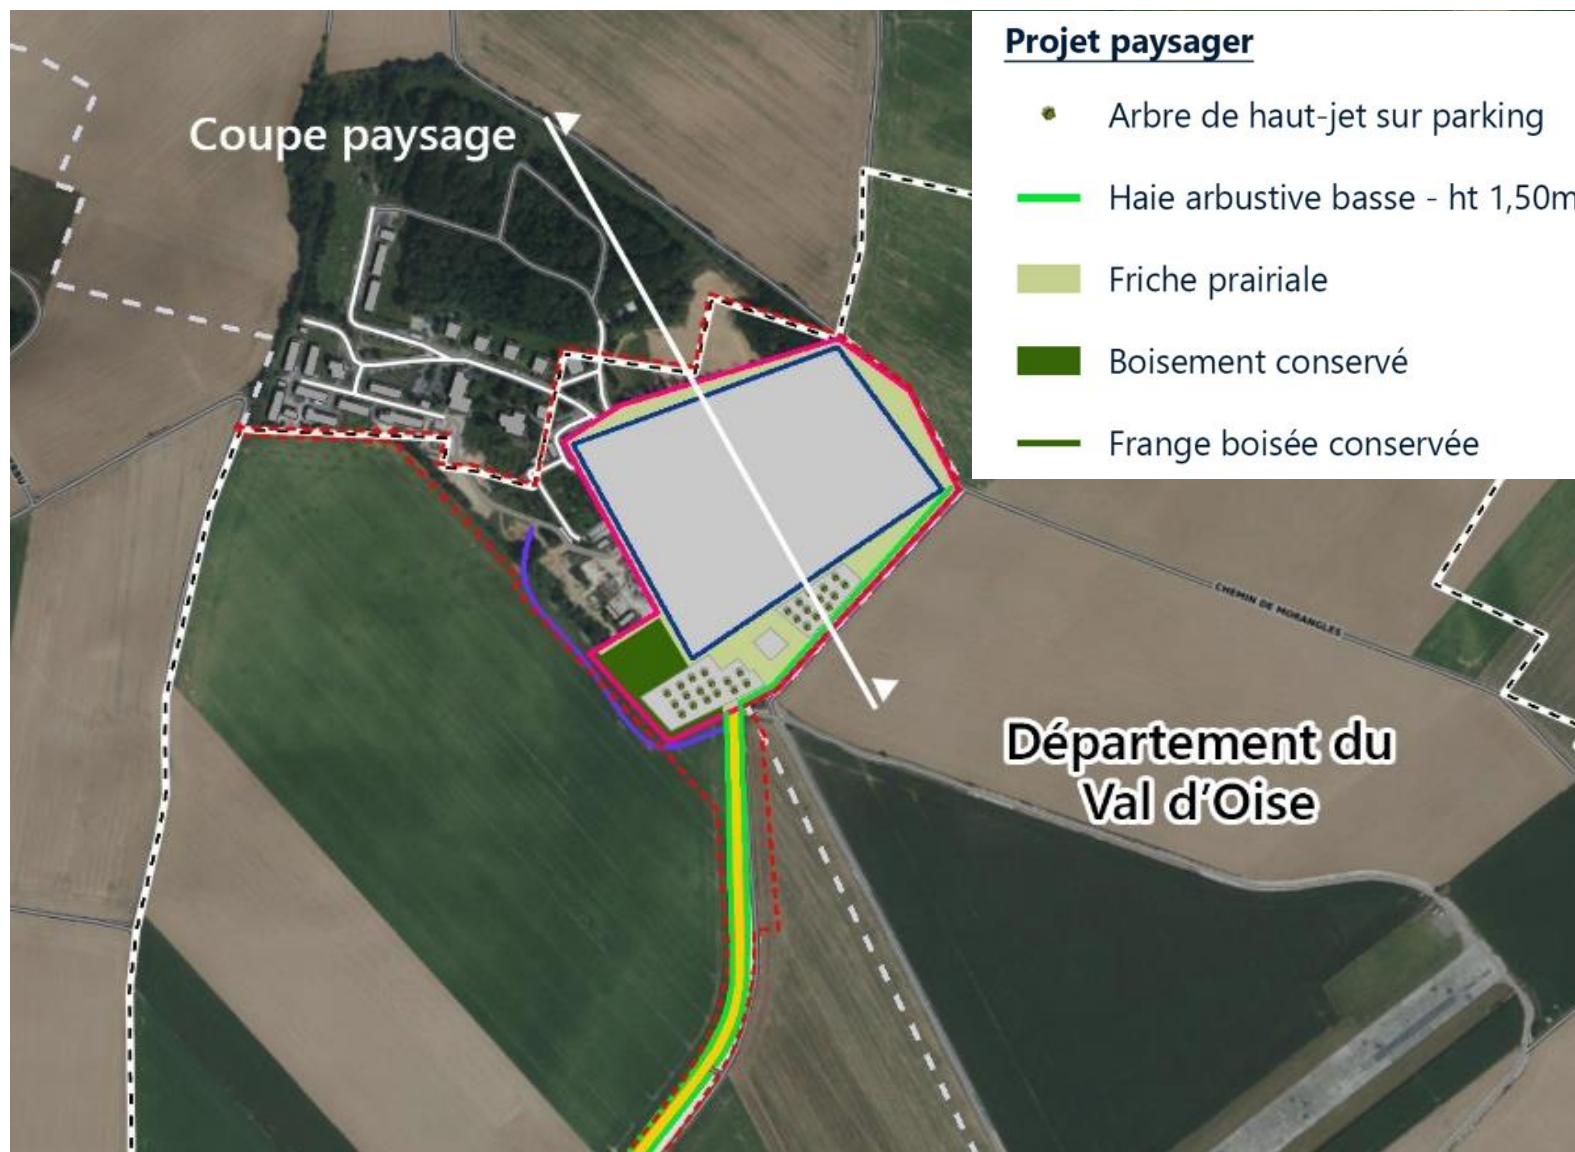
Proposition de plan de masse paysager (issu d'une étude faisabilité)
